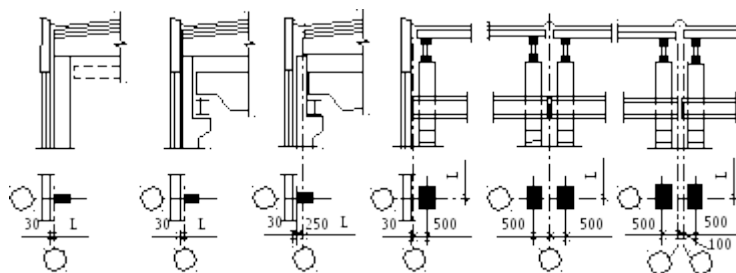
Привязка элементов одноэтажных промзданий к продольным и поперечным разбивочным осям. а, б – нулевая привязка колонн и наружных стен к продольным разбивочным осям; в- то же, привязка «250»; г – привязка к поперечным разбивочным осям в торцах зданий; д, е – то же, в местах поперечных температурных швов.
